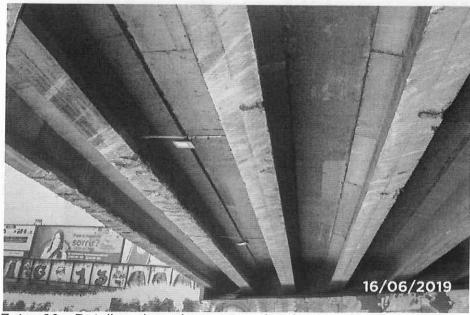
Detalhe das vigas com desplacamento de concreto, armaduras expostas e rompidas.
